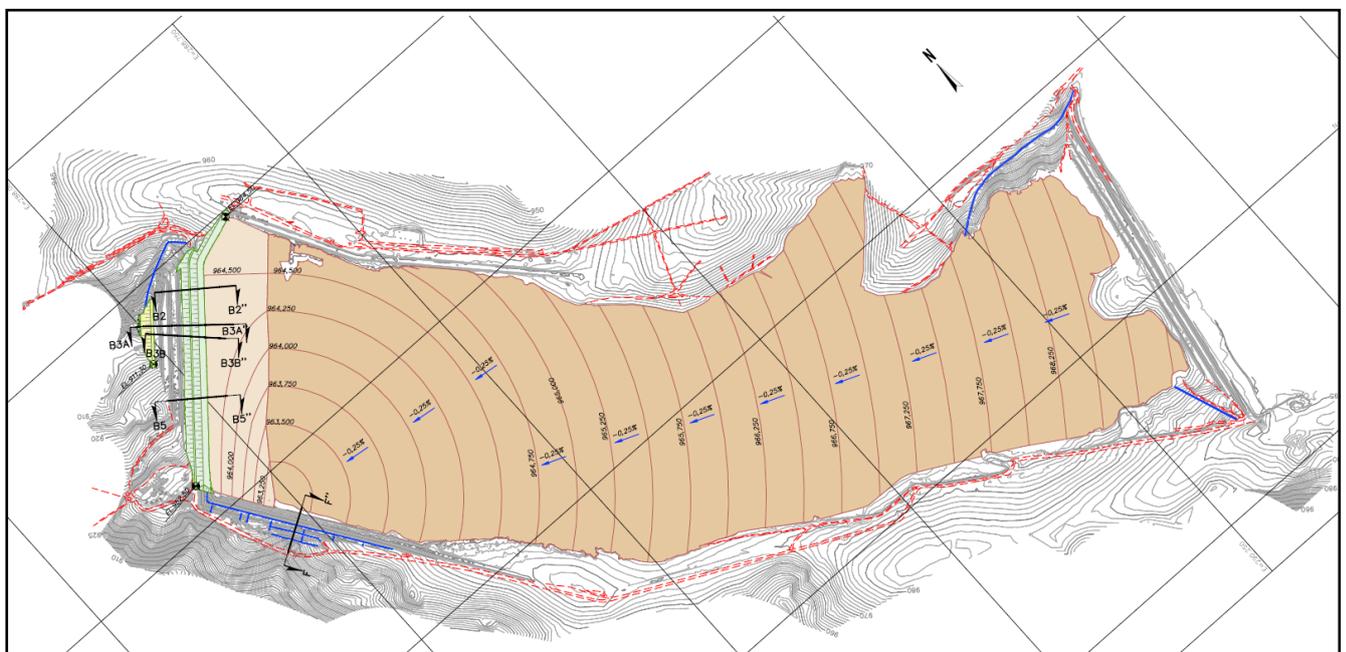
Arranjo Geral do projeto de descaracterização da Barragem B5.
